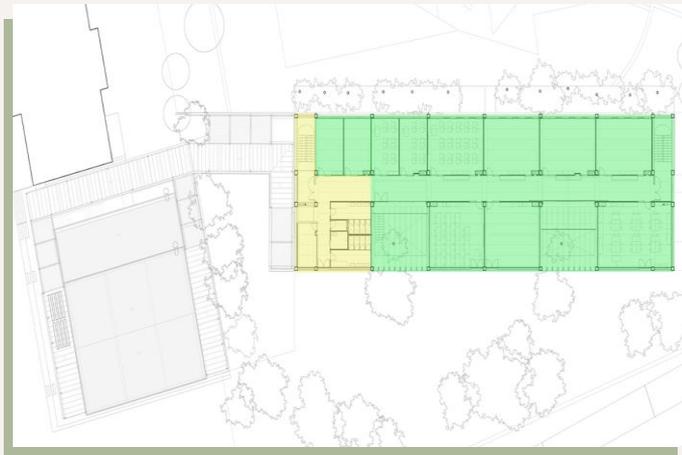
PLANTA 2º PAV. DO INSTITUTO BADIA I MARGARIT
